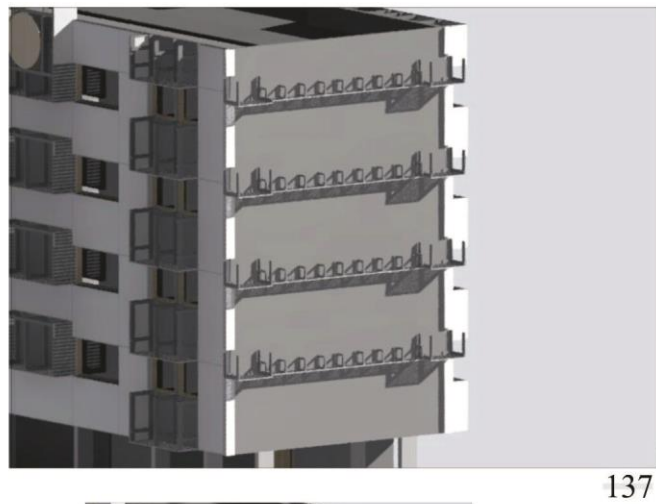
e 134: Sistema construtivo e fachada posterior canto,
